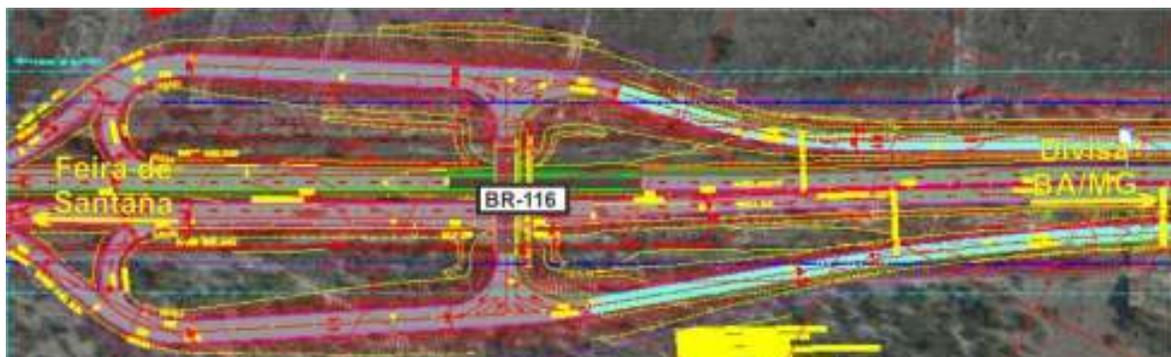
Projeto Proposto – Dispositivo km 521+600 da BR116
